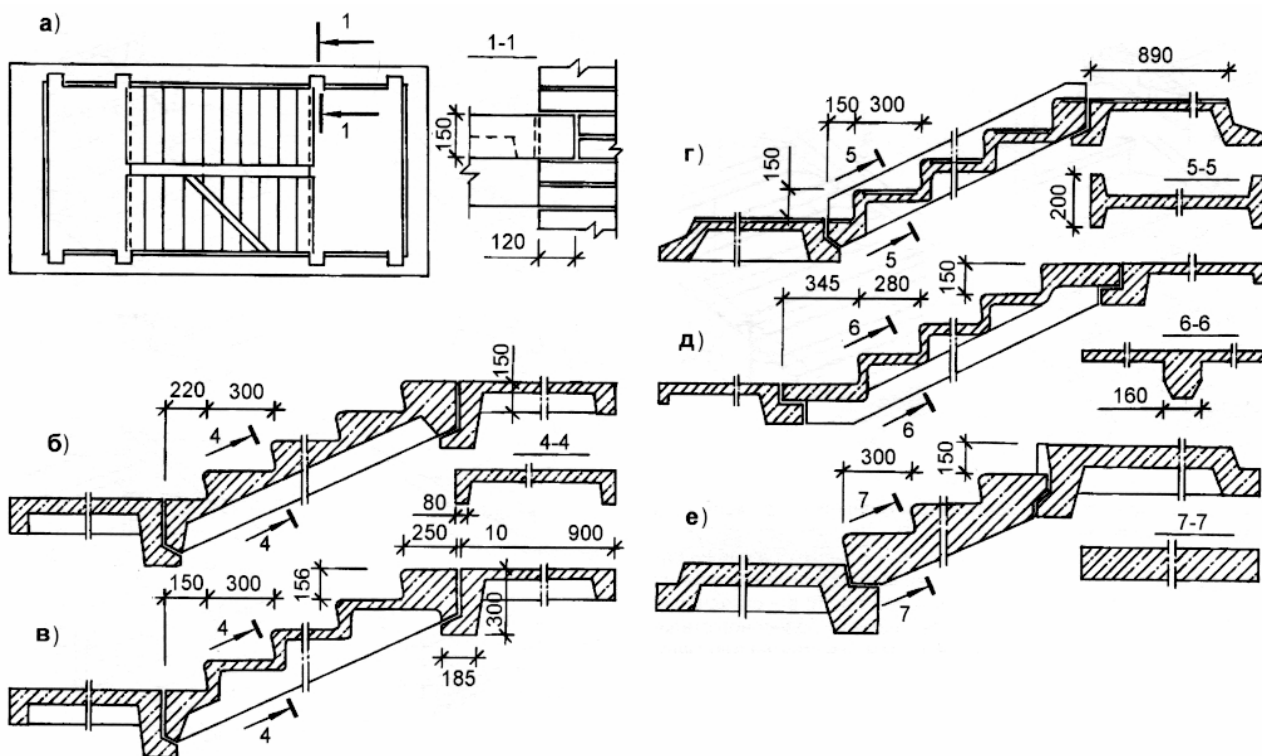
Лестницы из крупноразмерных железобетонных элементов:
